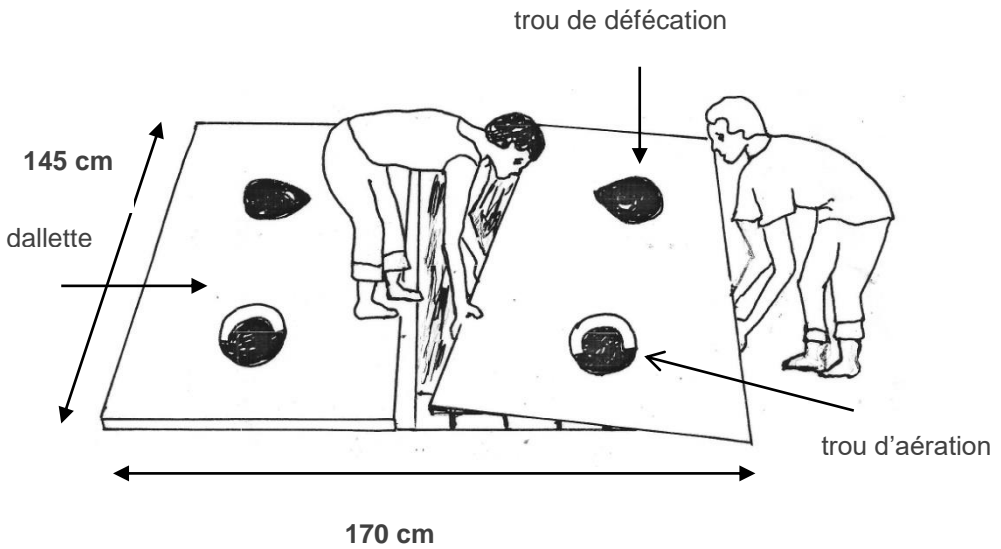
Pose des dalles sur la fosse d'une latrine Ecosan
